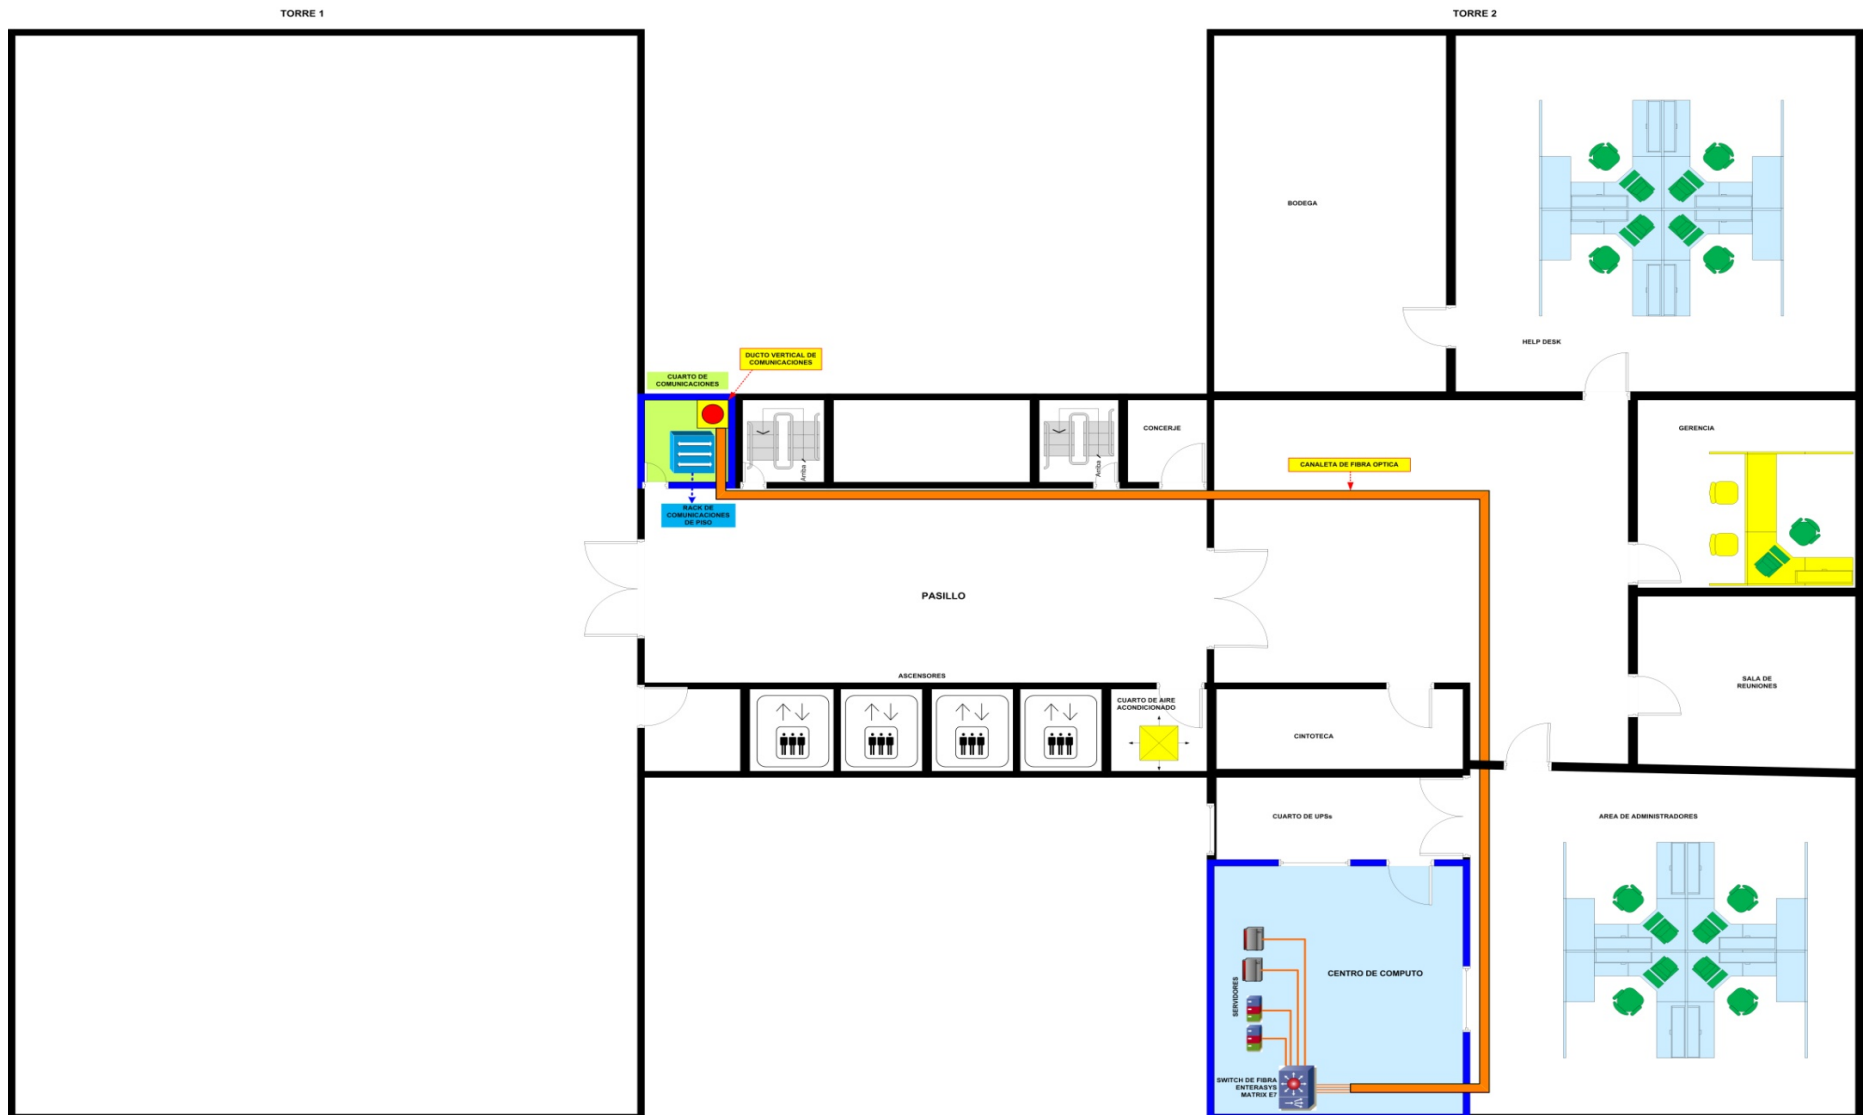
Tendido de la bandeja horizontal empotrada en el techo, para el ducto de fibra óptica
